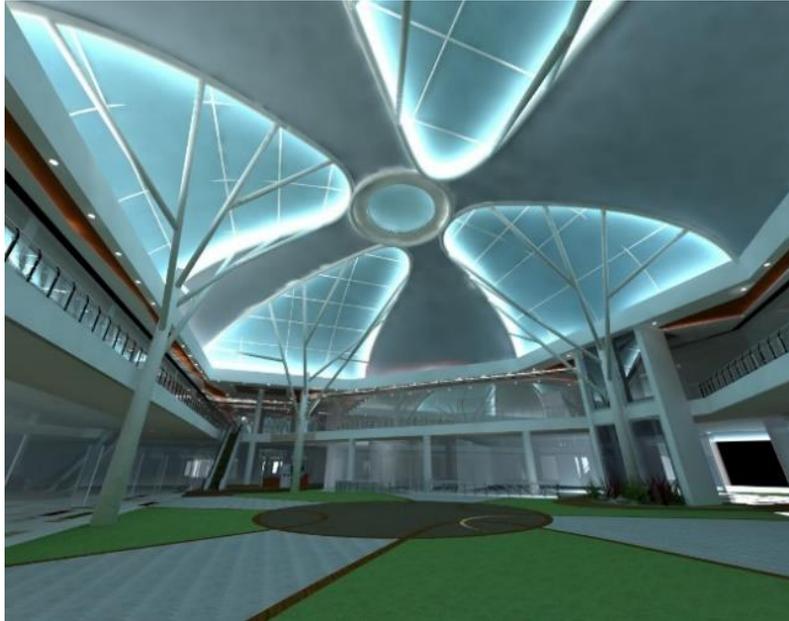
Cubierta plazoleta central en planos arquitectónicos. Fuente: Departamento de diseño arquitectónico Arinsa.
